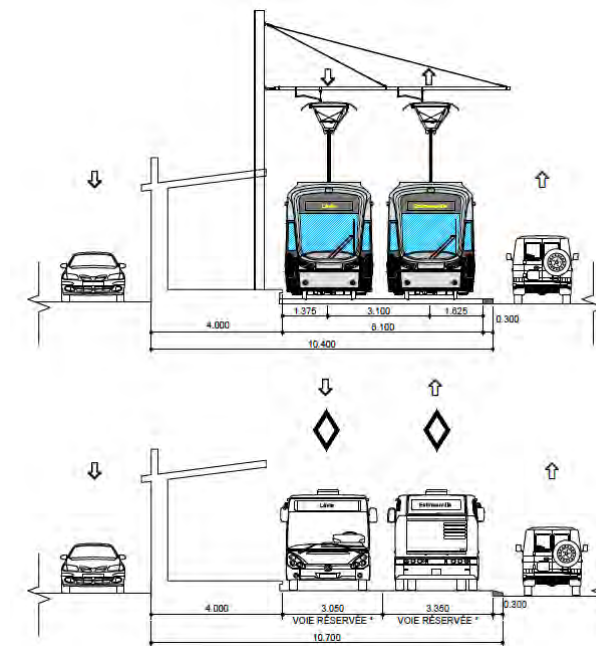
Coupe type 07 de 15 - SRB - Site espace restreint semi-franchissable - Station à quais décalés
